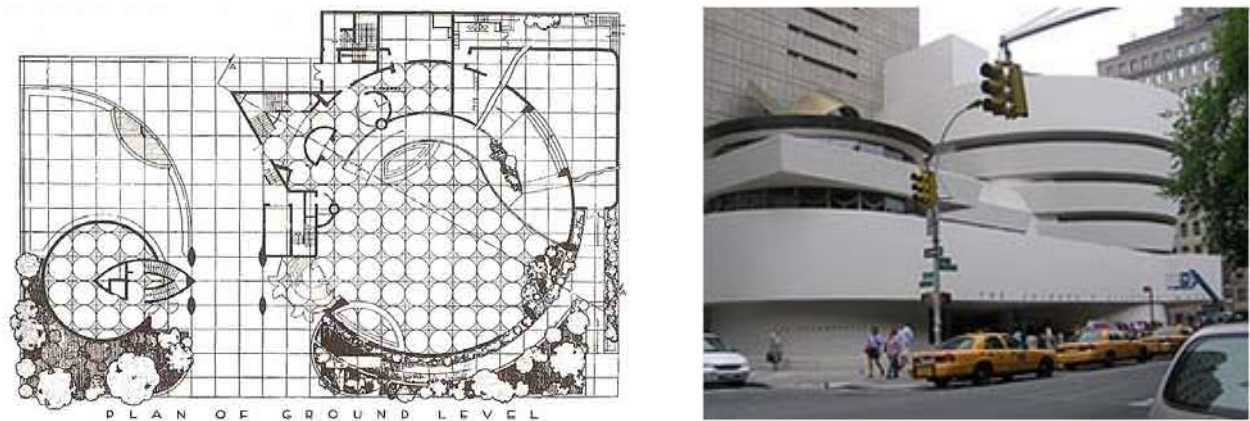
Representación del límite como una banda activa; planta y alzado (Museo Solomón R. Guggenheim).
